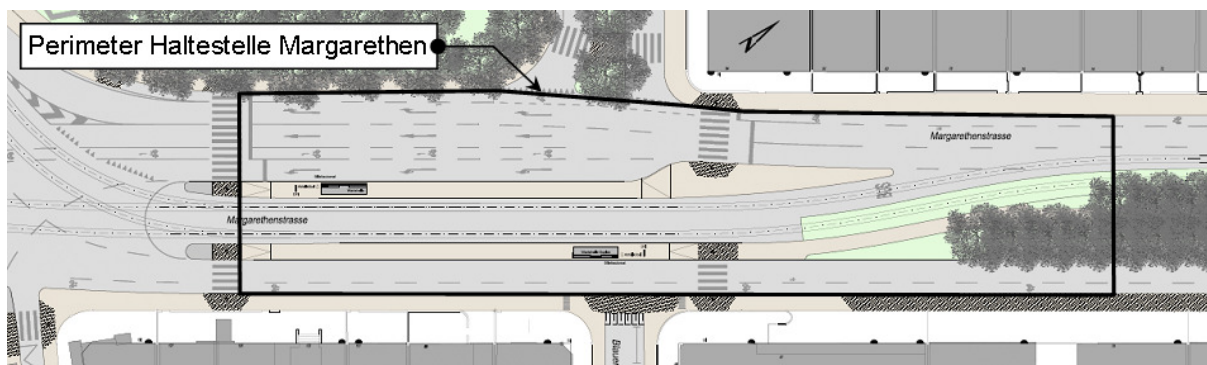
Ausschnitt aus Projektplan neue Situation Haltestelle „Margarethen“
